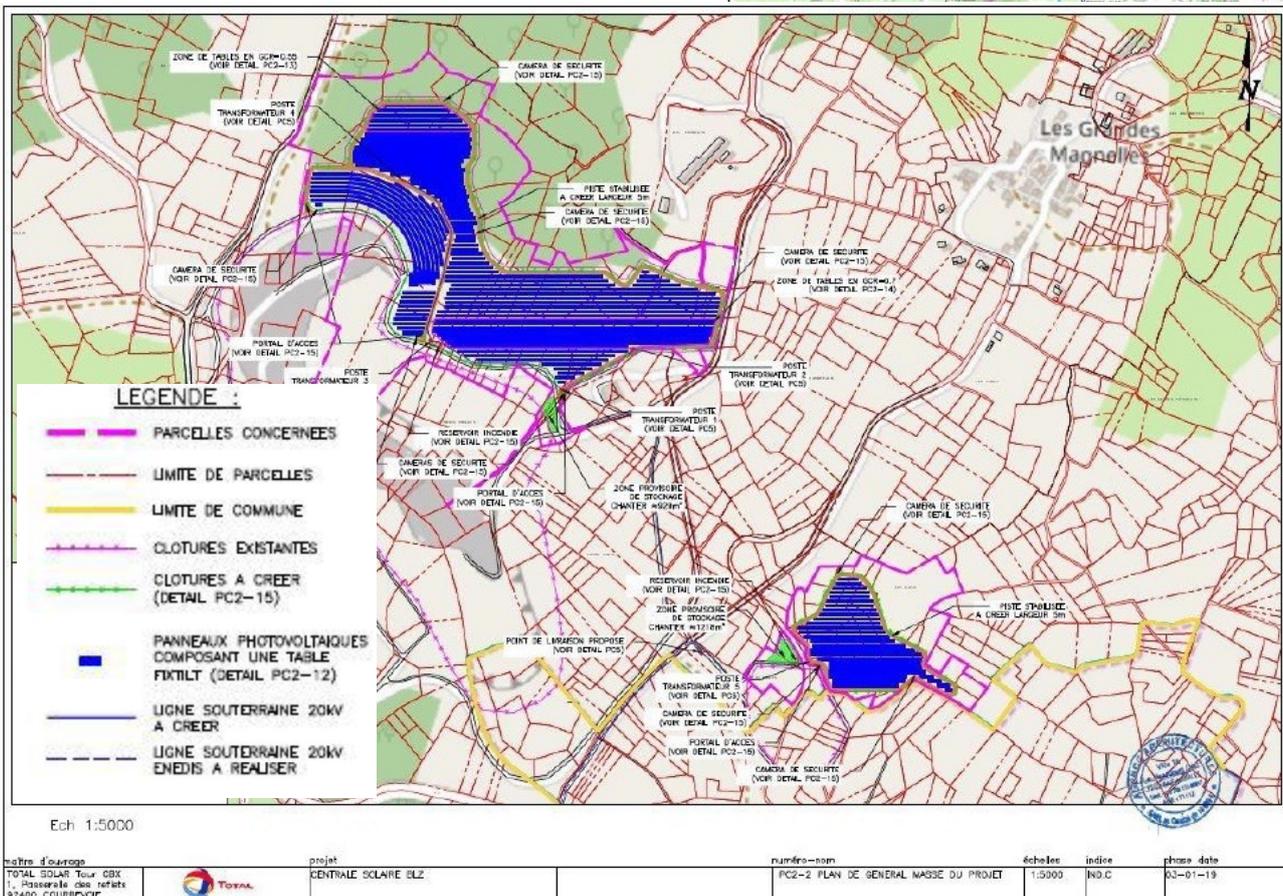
Plan d'implantation des centrales photovoltaïques sur l'ensemble du site - Source : Total Solar, Dossier de permis de construire.
